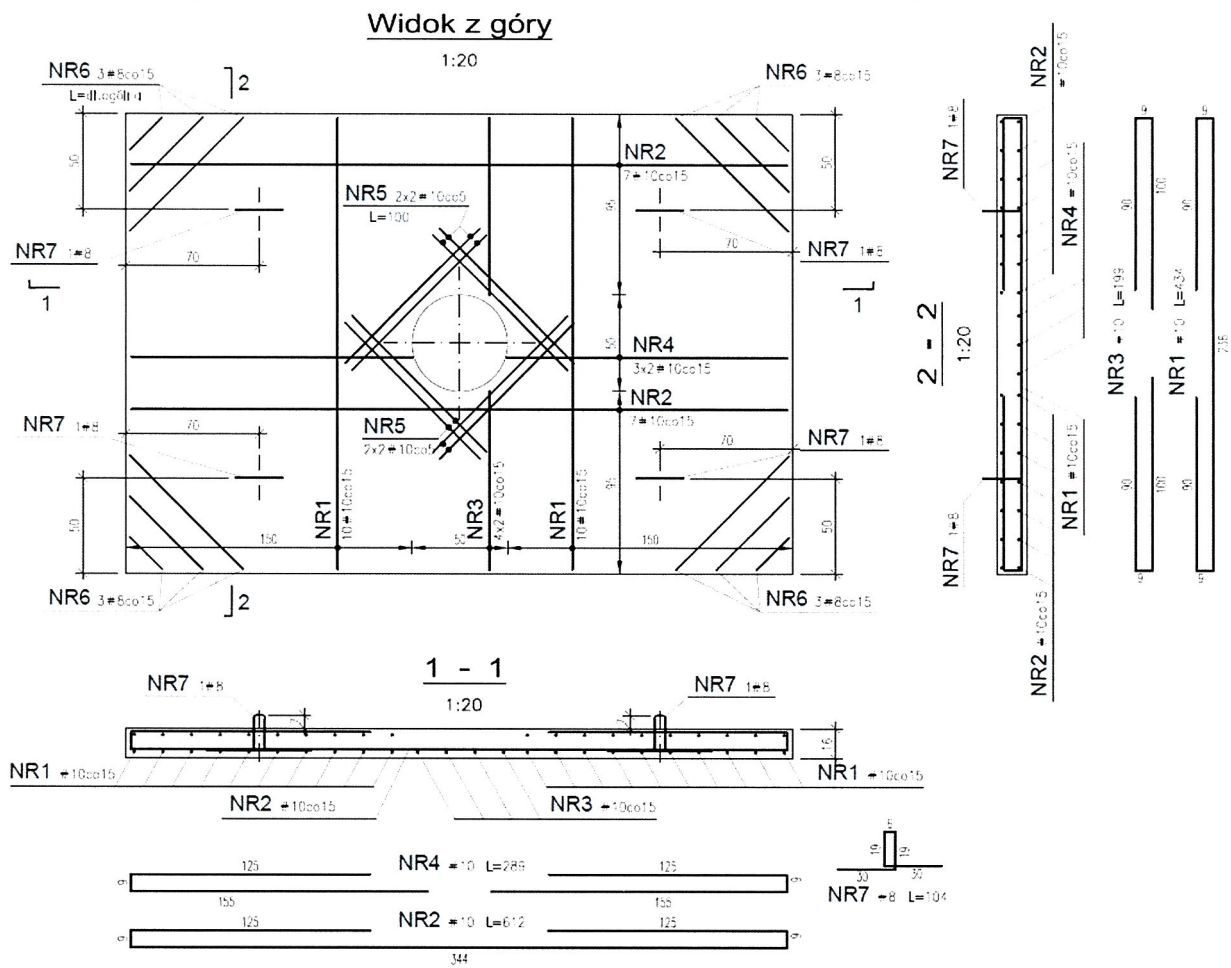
Zbiornik żelbetowy Eko+ 12
